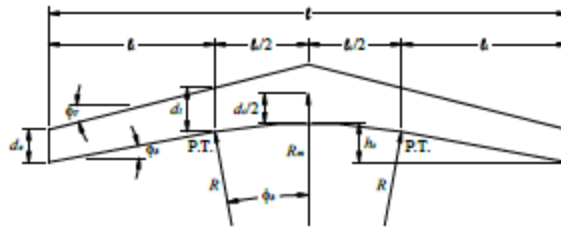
Miembro laminado doblemente ahusado
